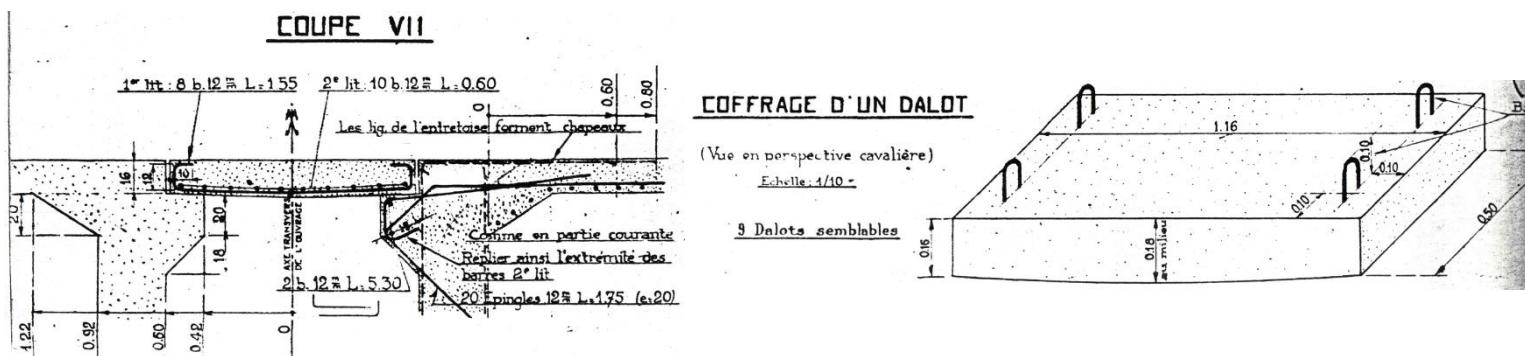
Détail du plan de conception des joints cantilevers (Plan de ferrailage du Hourdis du Pont de St Capraise-de-Lalinde 1928)
